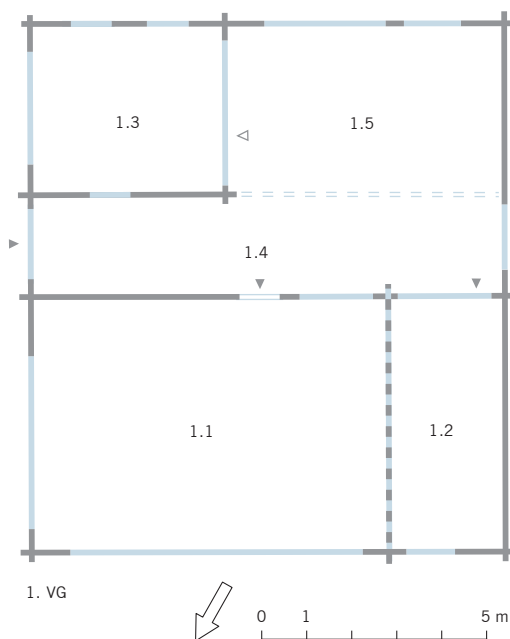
Hauptstrasse 1 in Oberägeri, Grundriss des ersten Vollgeschosses.
